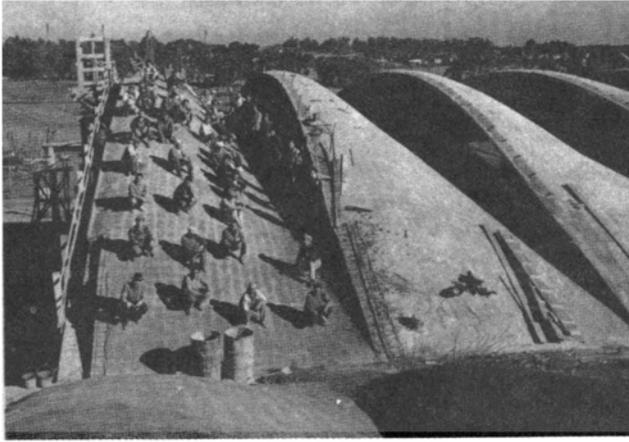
Un cascarón de ladrillo armado sometido a una prueba de carga al día siguiente de su construcción.
